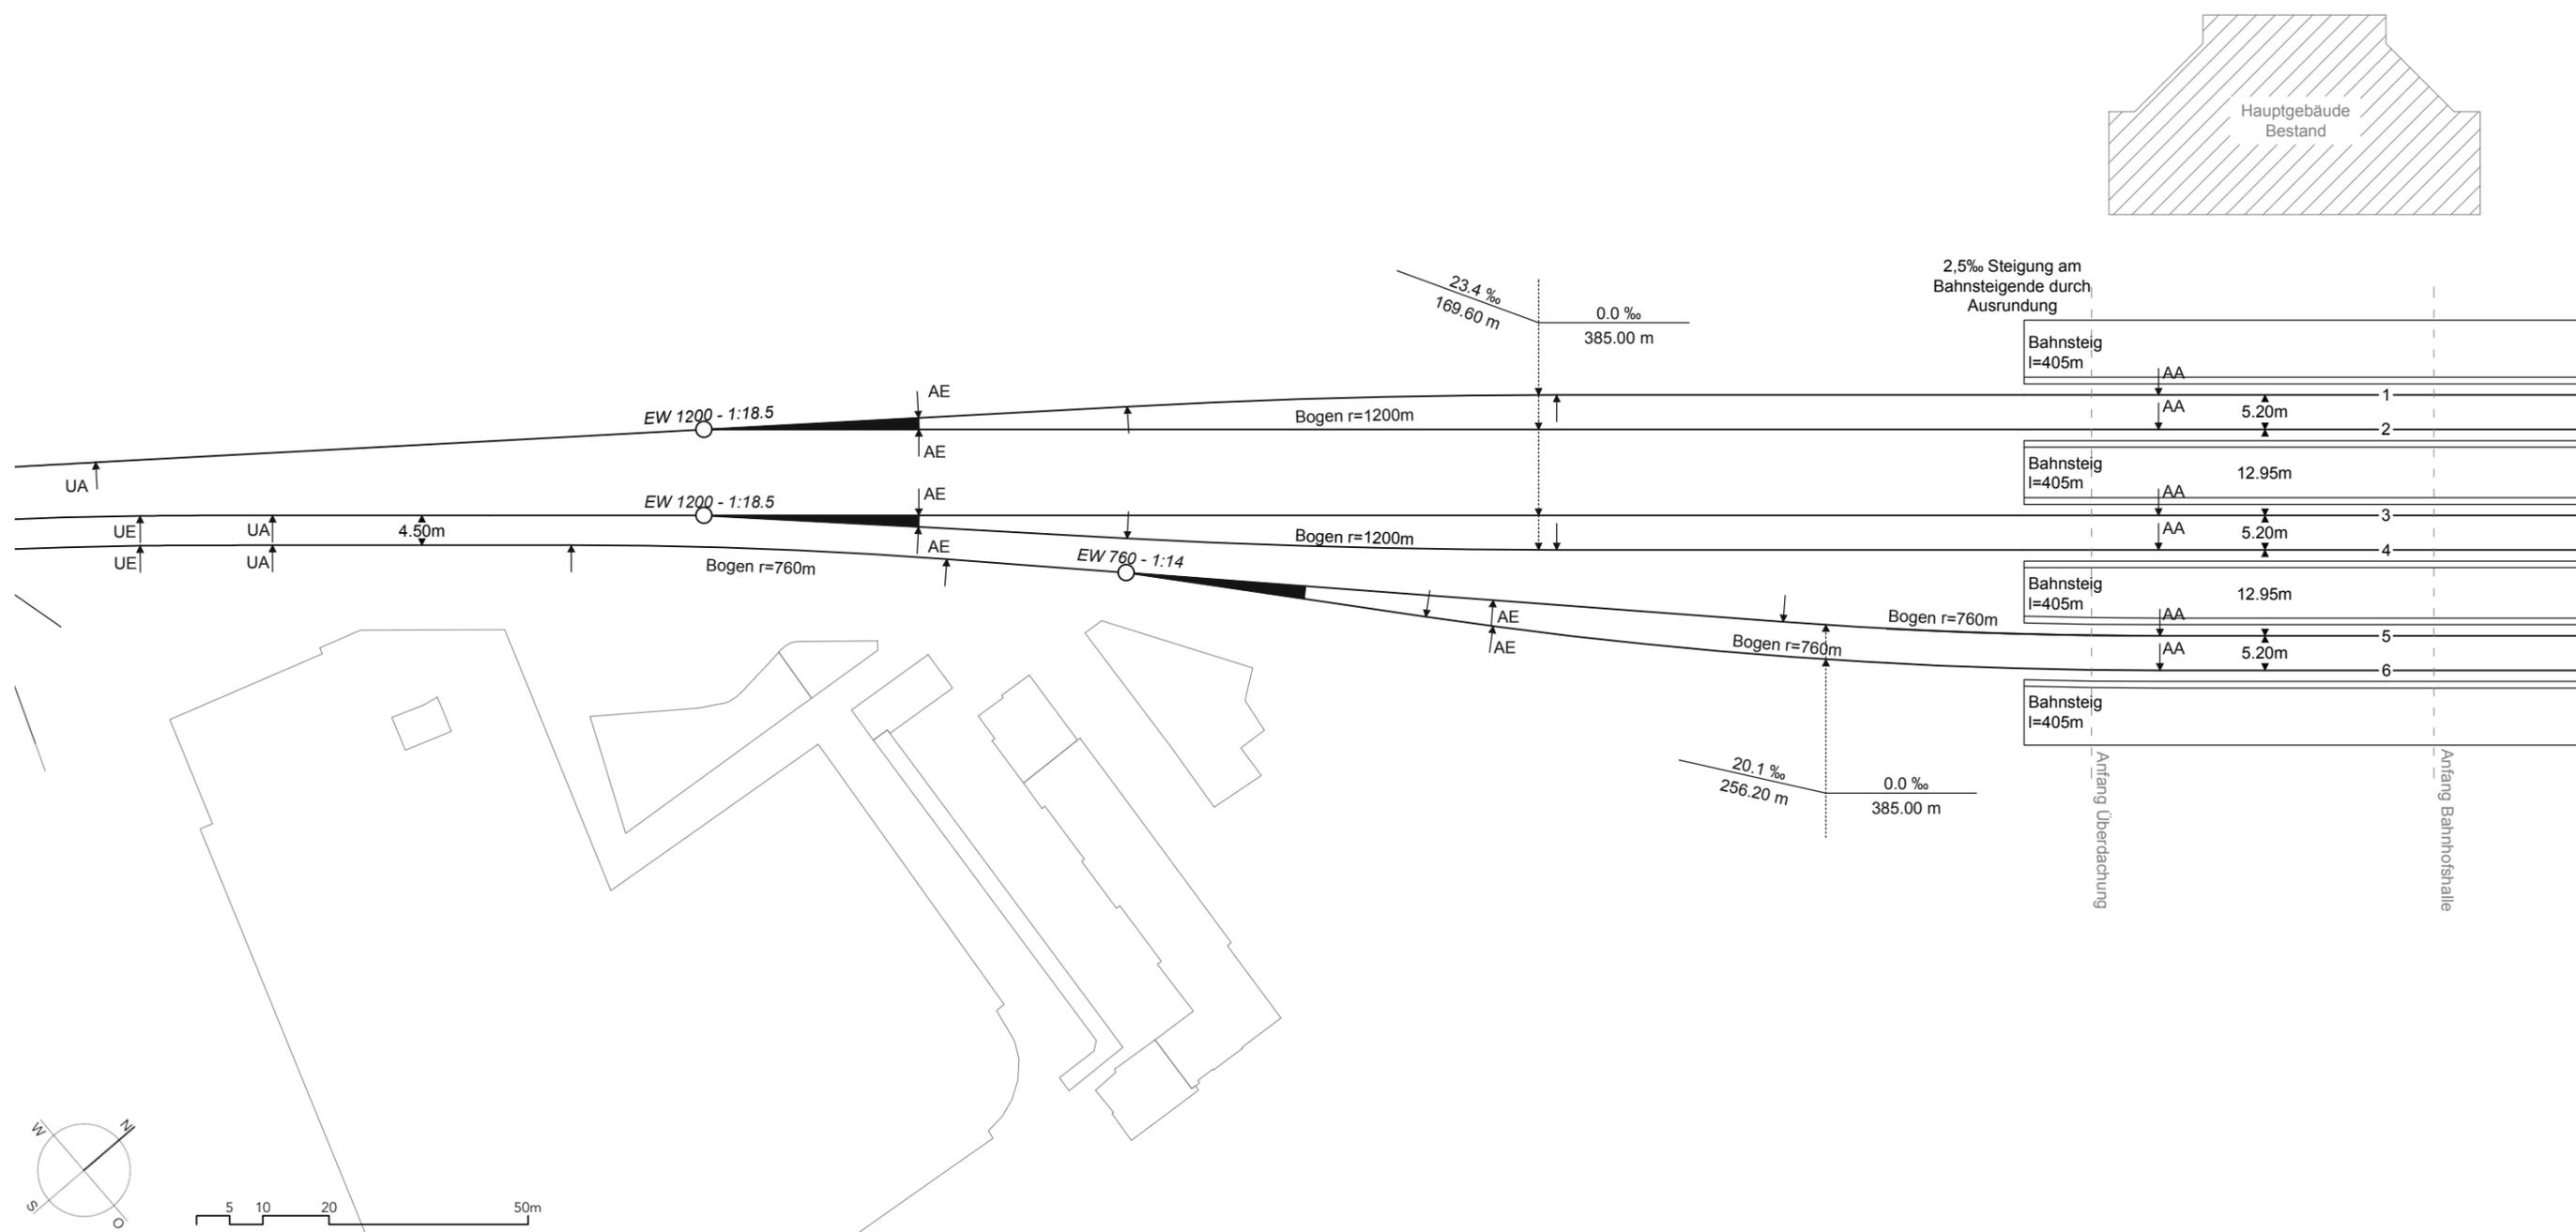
Lageplan Schienennetz Rampe und Bahnhof 1:1000
